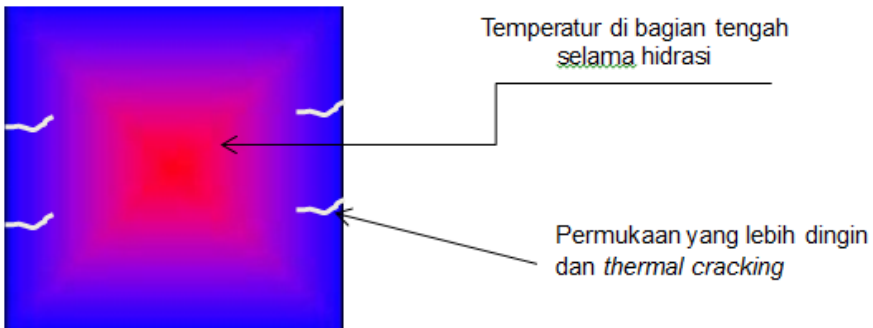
Contoh Beton Massa yang Mengalami Retak *Thermal
